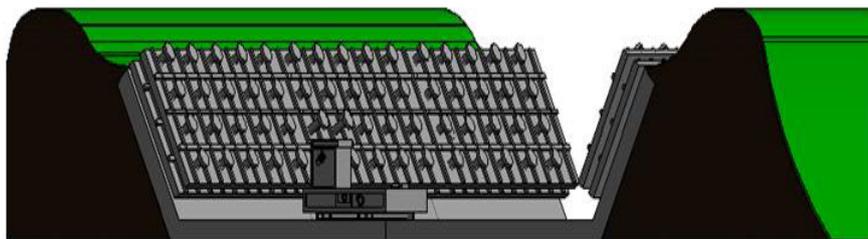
完成一种边坡支护钢筋混凝土桩项目研究报告
